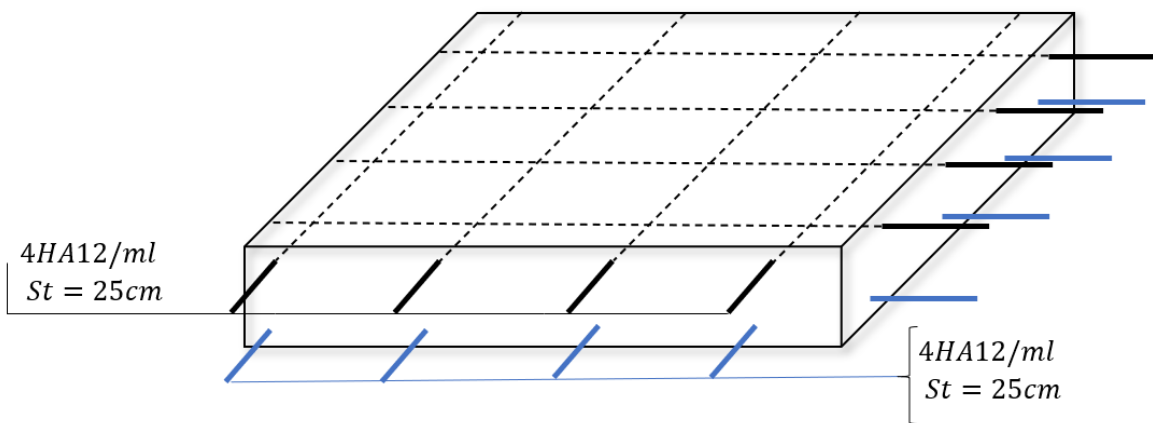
Coupe 2 de ferrailage pour plancher à dalle pleine.
